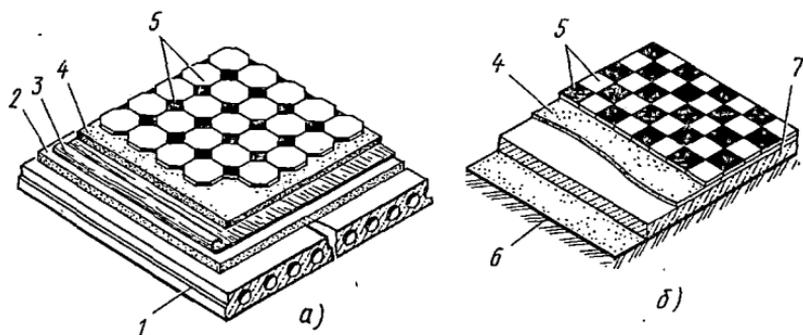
Конструктивные элементы полов, устроенных на перекрытии (а) и на грунте (б):
